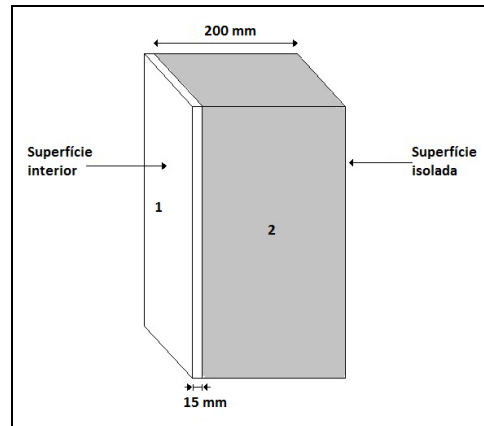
Dimensões e constituição da parede de Betão. 1 - Reboco, 2 - Betão.
